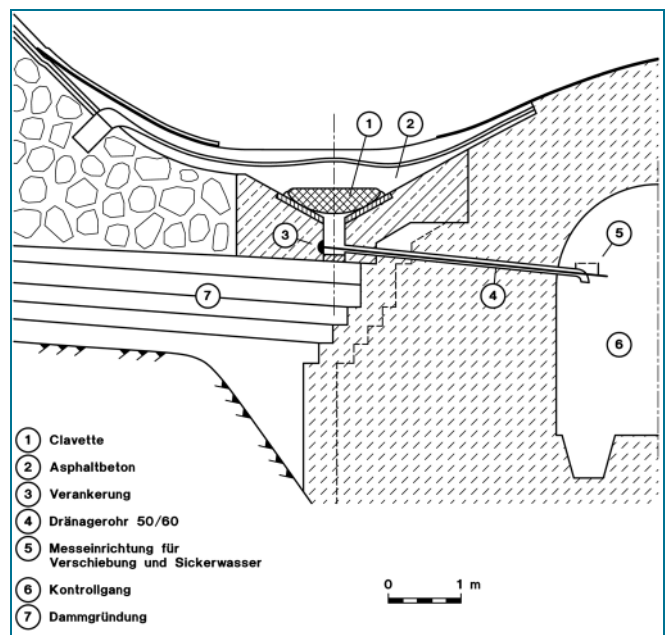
Konstruktive Ausbildung des Übergangs der Dichtung vom Dammfuß zur Untergrundabdichtung am Staudamm Bou Hanifia (Bild noch zu übersetzen)
